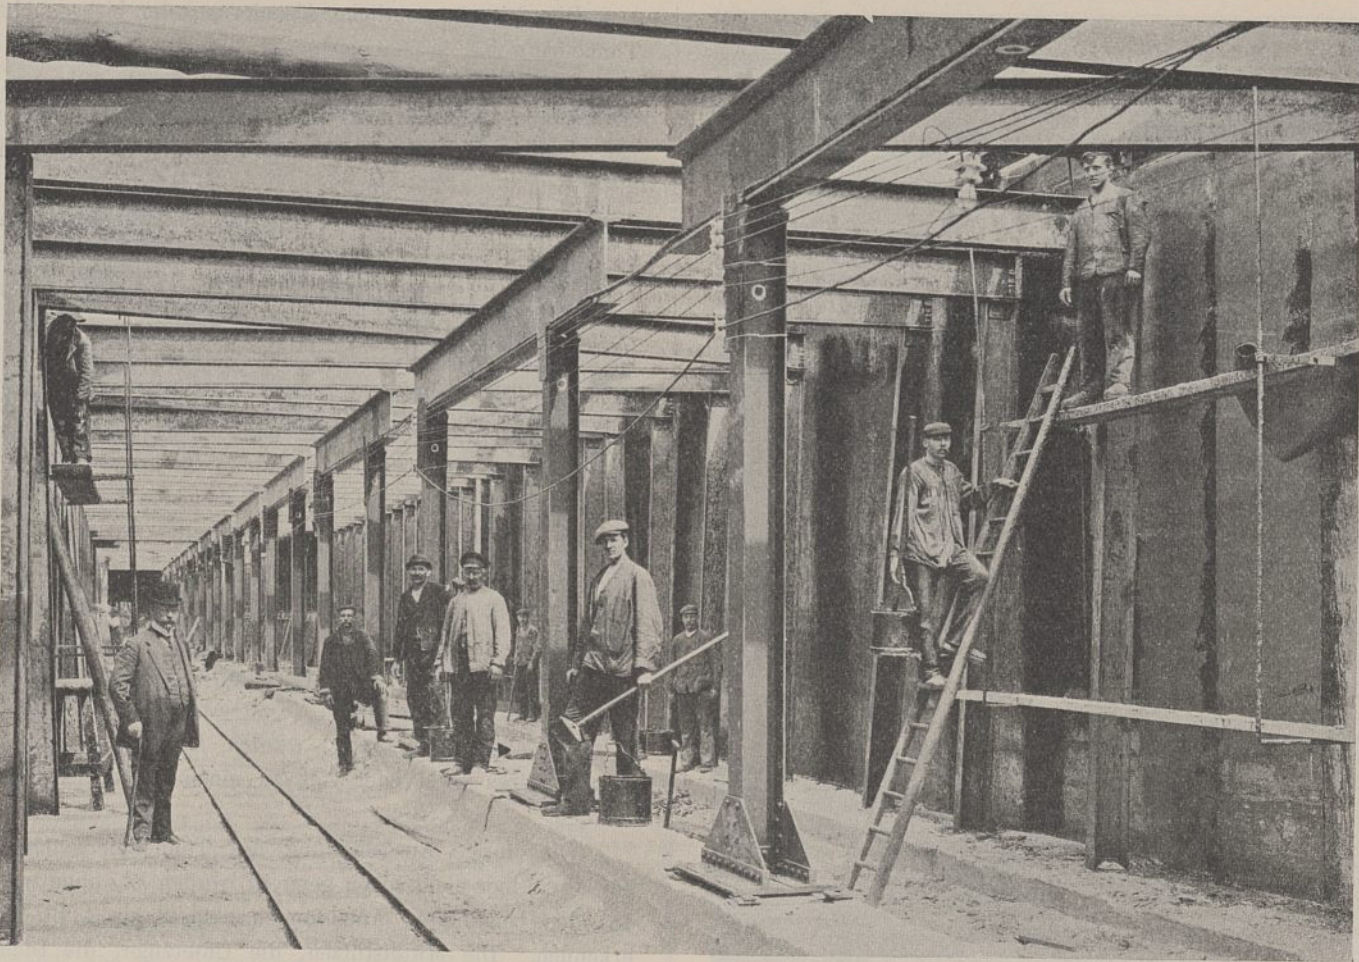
Eiseneinbau zur Herstellung des Tunnelkörpers.
